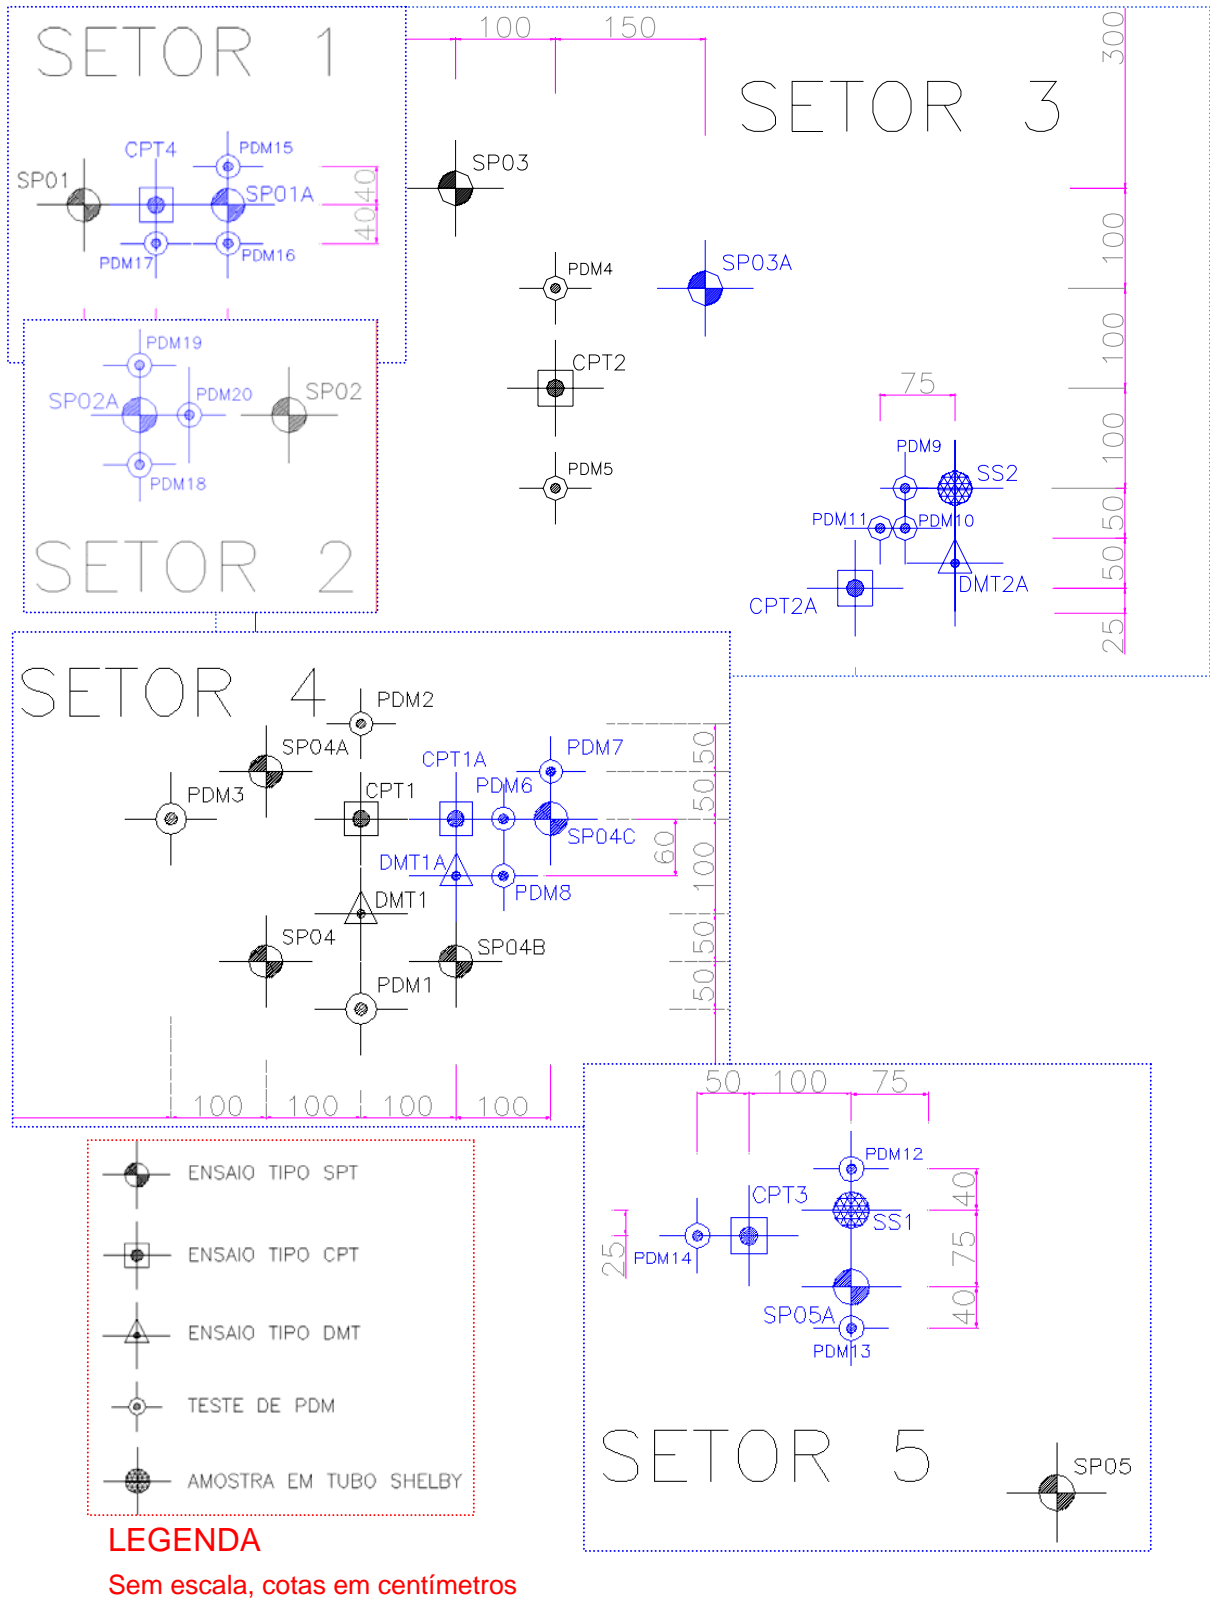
Planta de locação dos ensaios de campo, por setor
